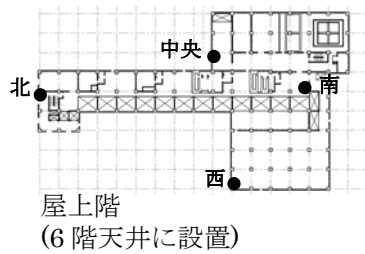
(1) 地震計配置 (MP 建家 断面図)
